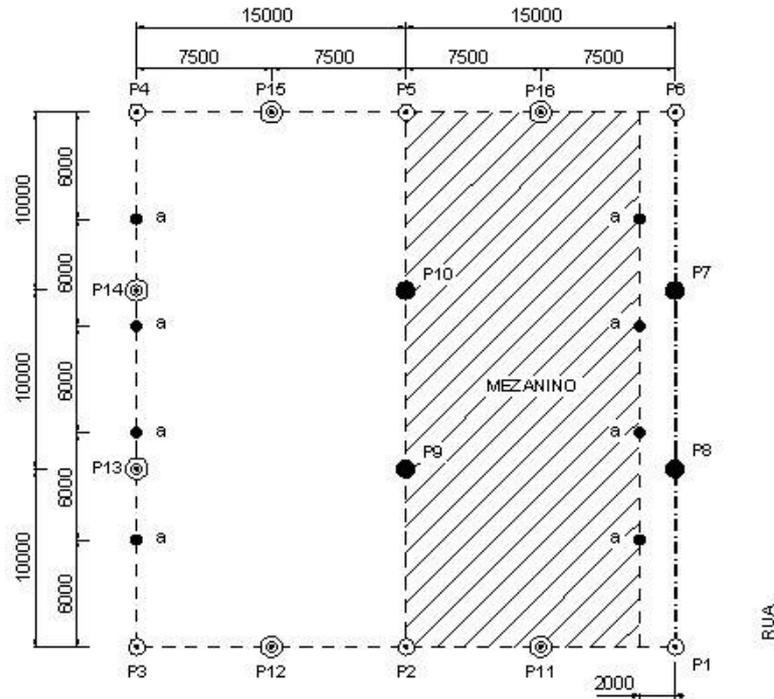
Disposição dos pilares no projeto do protótipo.
